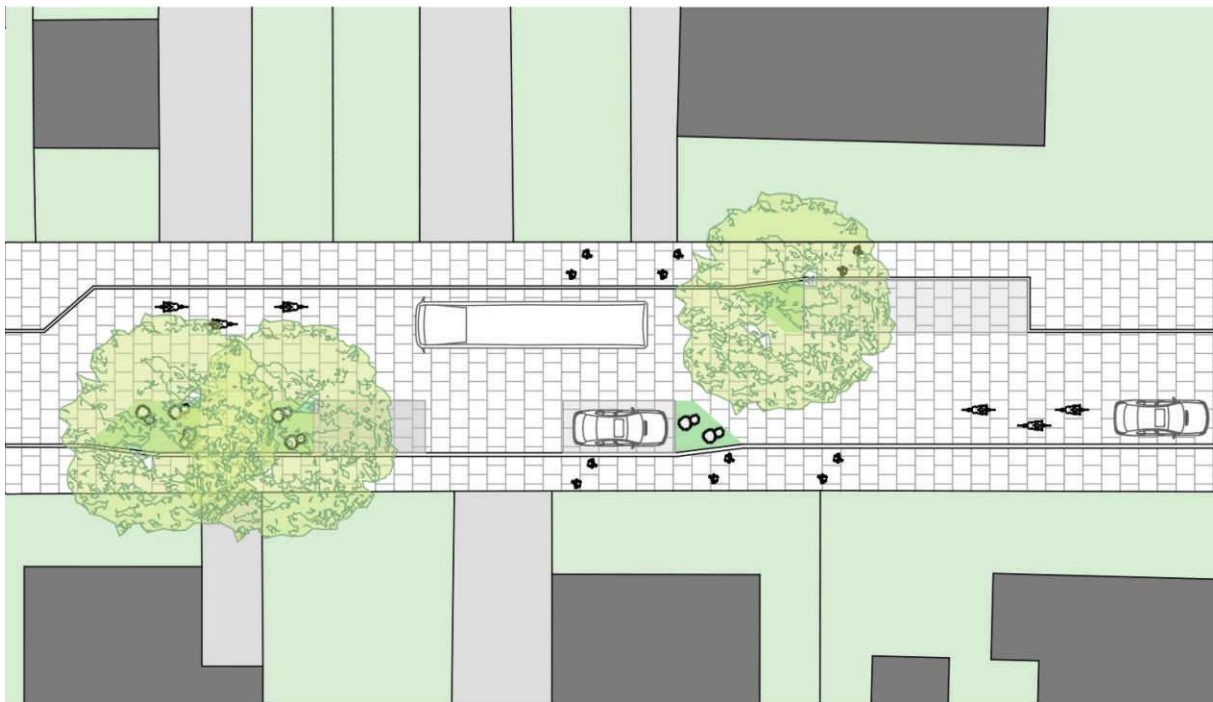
Grundriss Tempo 30 Straße, eigene Darstellung
